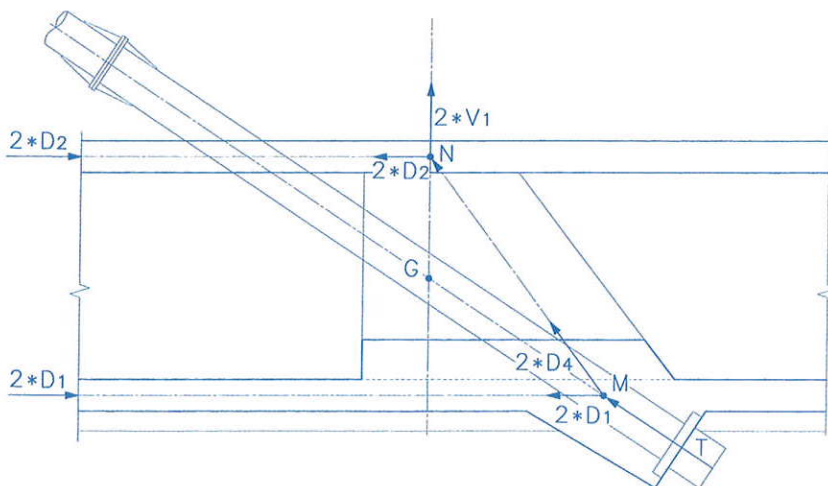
Esquema de las bielas de fuerzas en un anclaje de tirante vistas en Alzado (2D).
